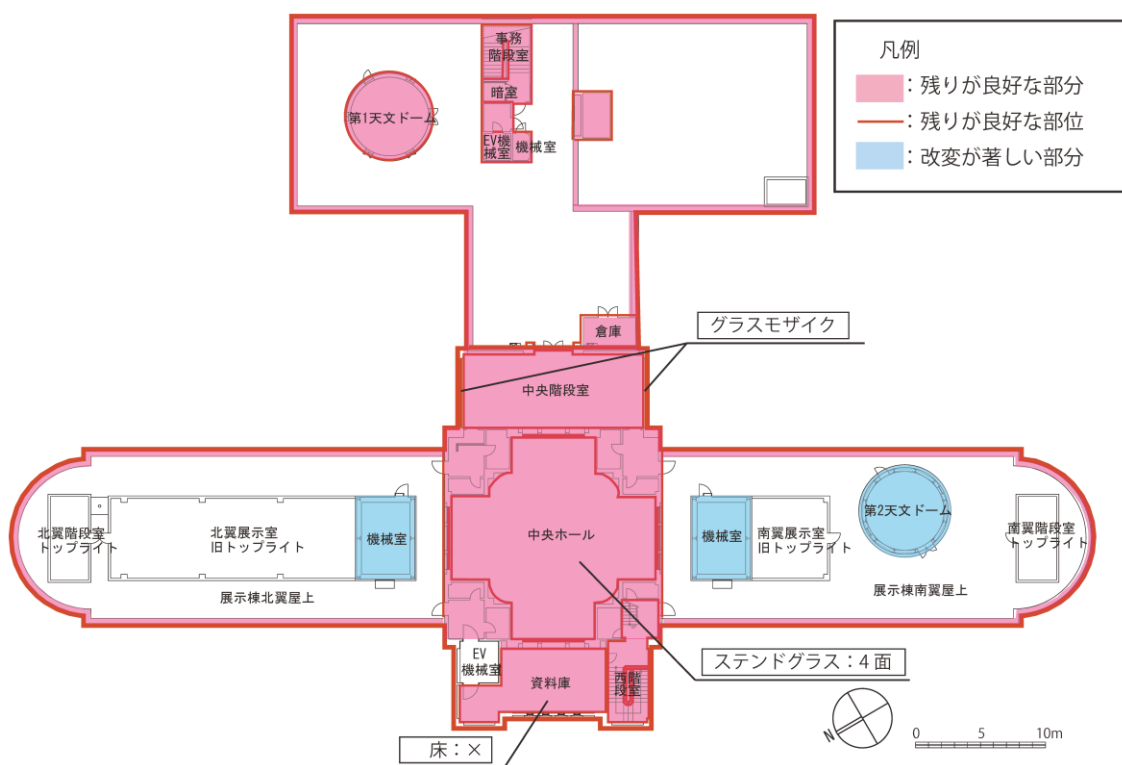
文化財的価値を有する部分・部位の残存状況 塔屋平面図（改修前4階平面図に加筆）
